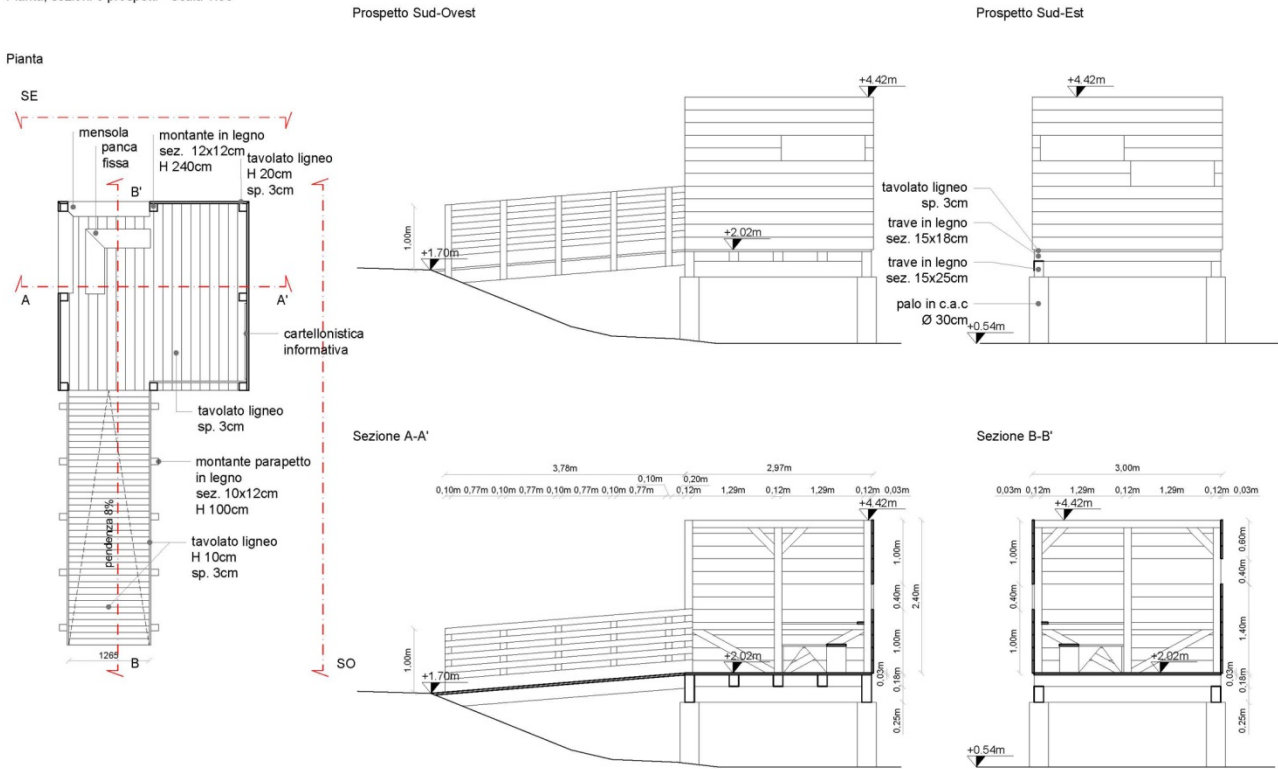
Pianta, sezioni e prospetti della postazione di birdwatching.
